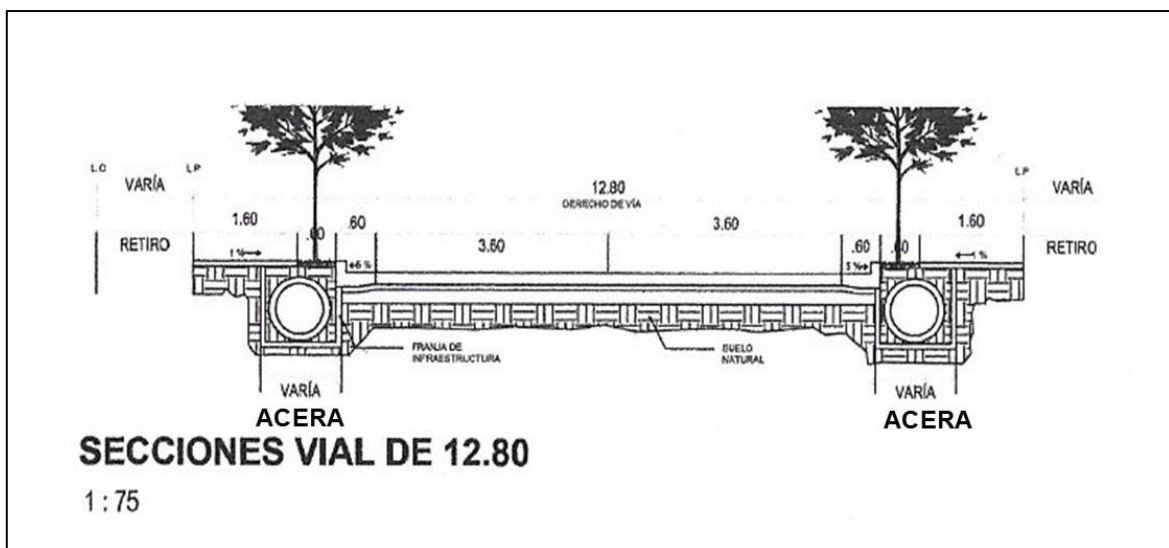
Sección de calle para la Lotificacion Selva Primera fase
